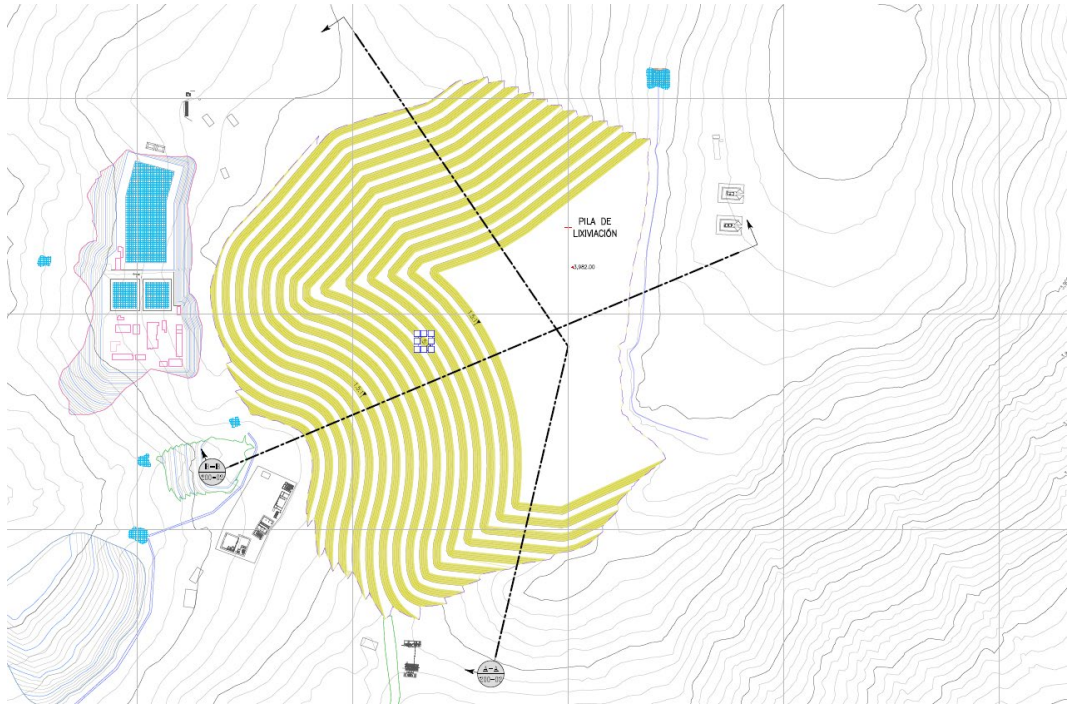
Ejemplo de vista de planta de corte de perfil A-A y B-B de una pila de lixiviación
